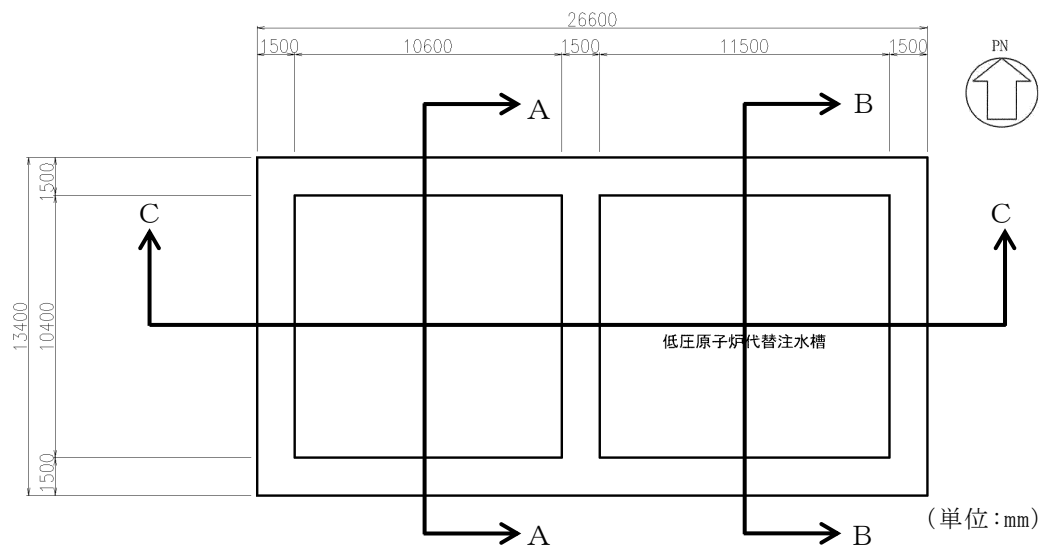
低圧原子炉代替注水ポンプ格納槽 平面図
